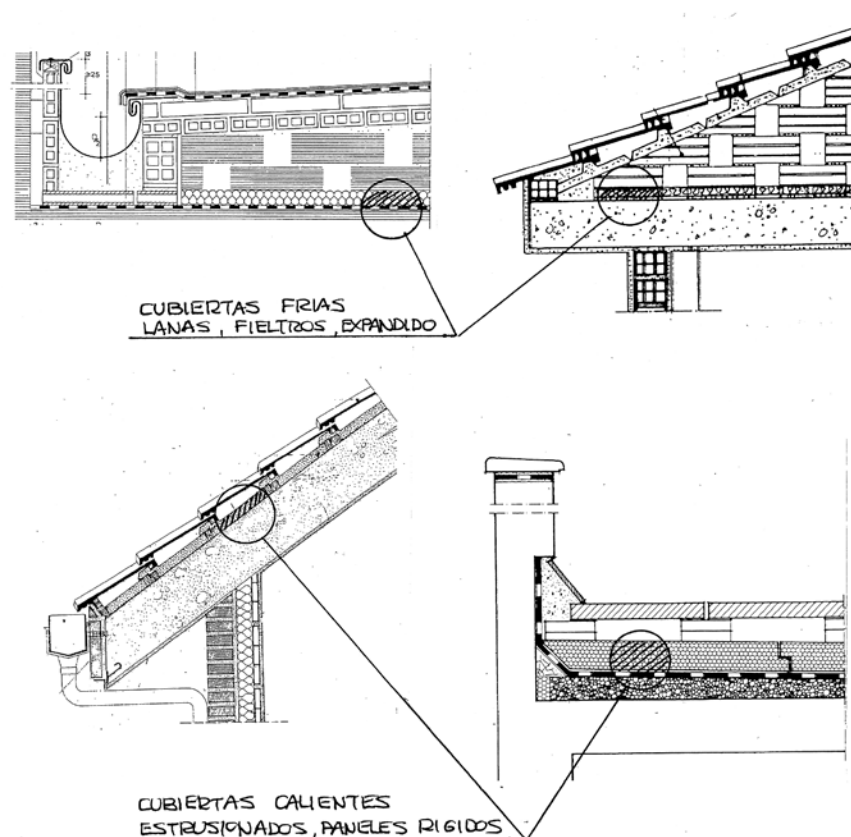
Aislantes adecuados para cada tipo de cubierta
